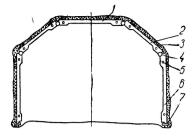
Рама полигональной железобетонной крепи из плит УРП-1: I — верхняк; 2 — подкос; 3 — клин; 4 — шарнирный вкладыш; 5 — межрамный болт; 6 — стойка; 7 — фундаментная плита
